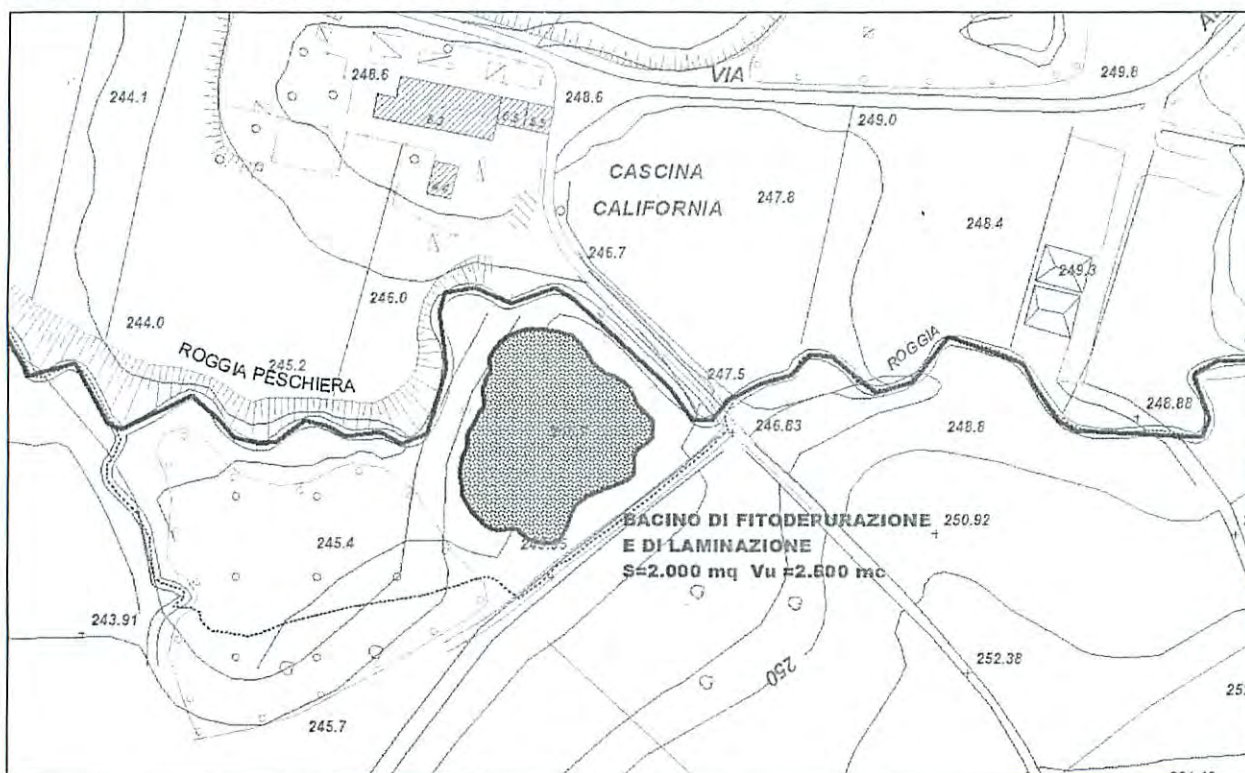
estratto planimetrico bacino di fitodepurazione in progetto
